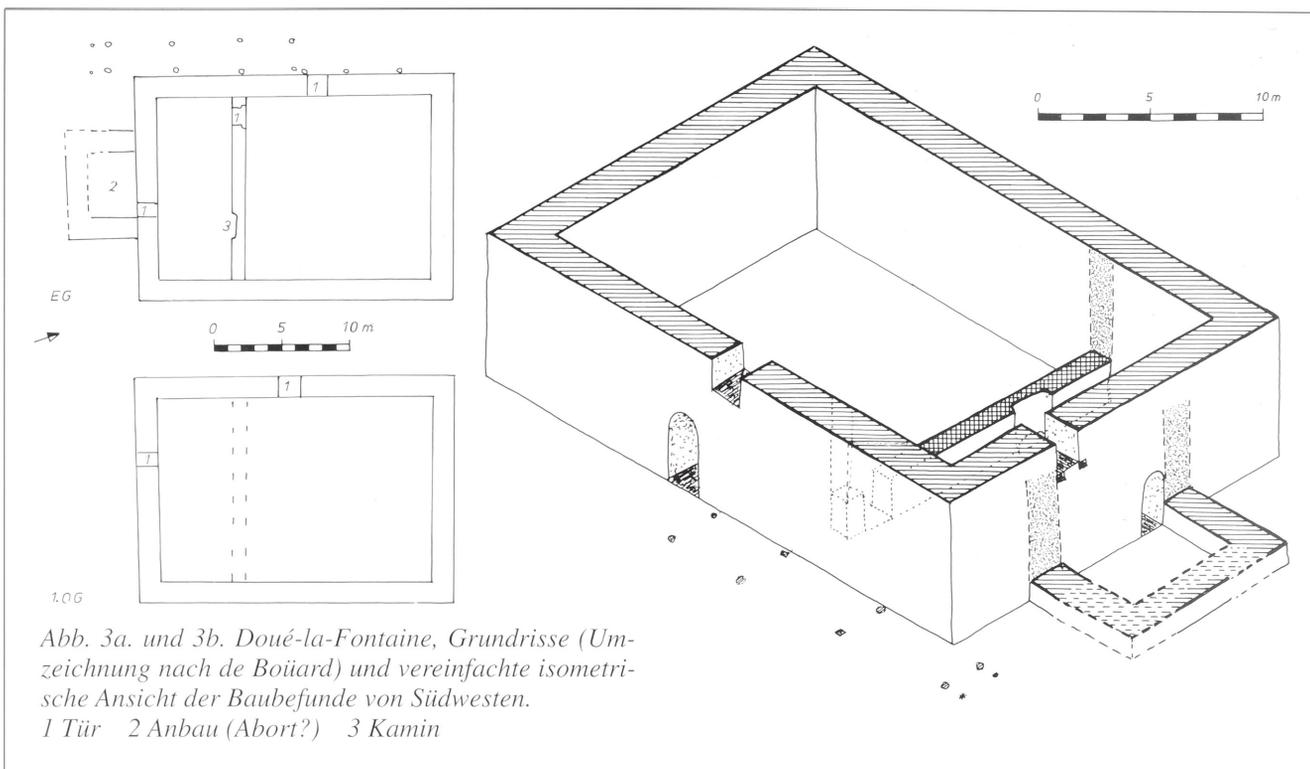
und 3b. Doué-la-Fontaine, Grundrisse (Umzeichnung nach de Boüard) und vereinfachte isometrische Ansicht der Baubefunde von Südwesten.
